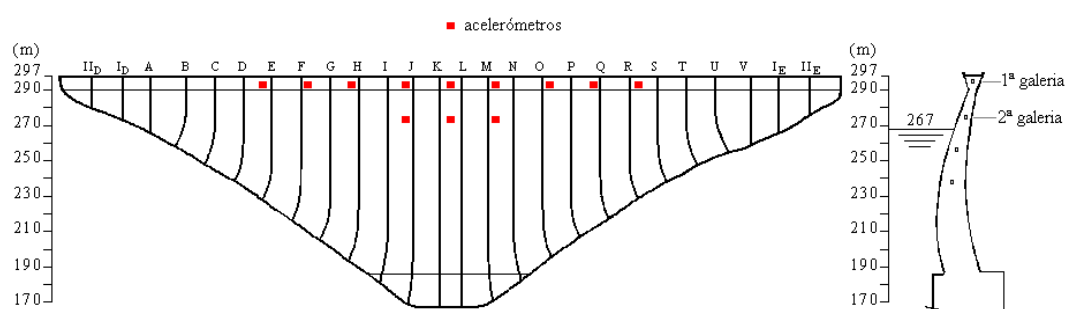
Alçado e corte pela coluna central da barragem do Cabril.
